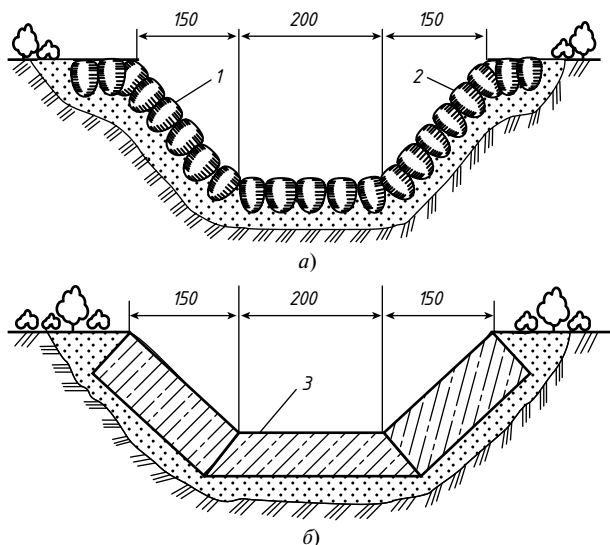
Лотки для сбора воды с проезжей части и отвода ее в водоемы: *a* — мощенье; *b* — из бетонных плит; 1 — булыжный камень; 2 — песчано-гравийная смесь; 3 — бетонные плиты
